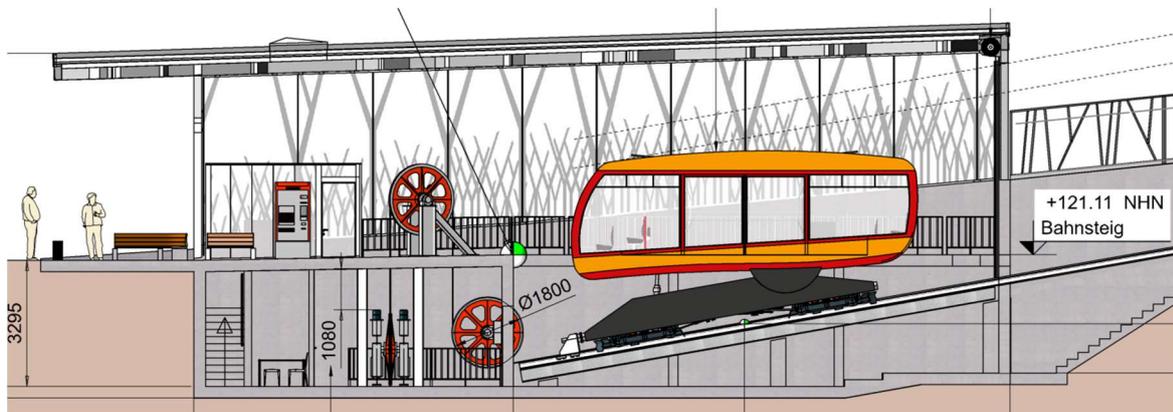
Schnitt geplante Talstation mit ebenerdigem Ein-/Ausstieg (Quelle: Garaventa)
